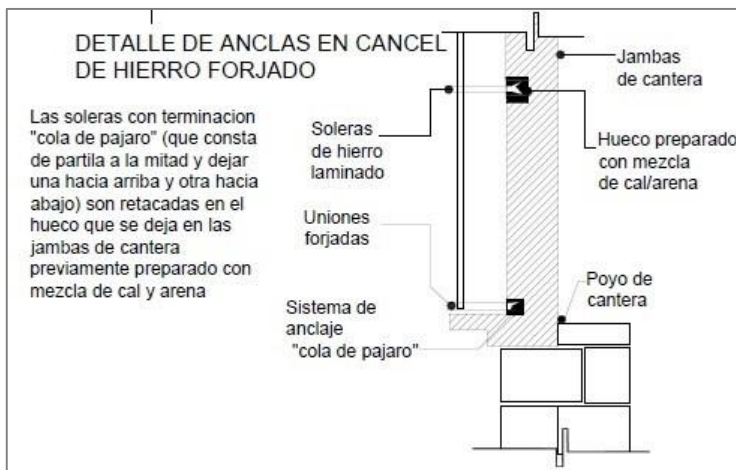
Croquis de anclaje de herrería en jambas de cantera. Fuente: Elaboración de la autora.
